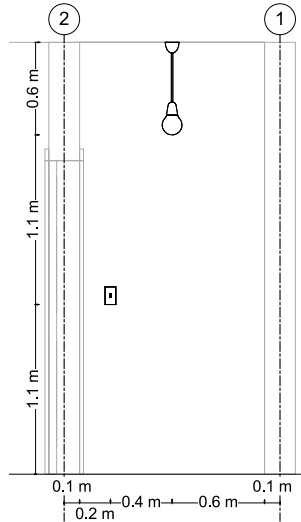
Plano de corte del baño, ubicación de foco y apagador.
